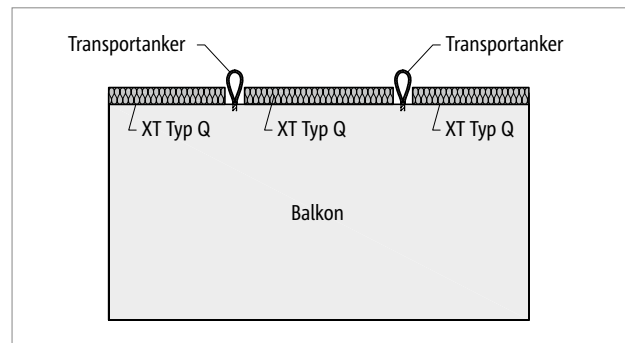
Schöck Isokorb® XT Typ Q: Vollfertigteilbalkon mit Transportanker; Dämmzwischenstück XT Typ Z muss beim Bestehen von Brandschutzanforderungen bauseitig eingelegt werden
